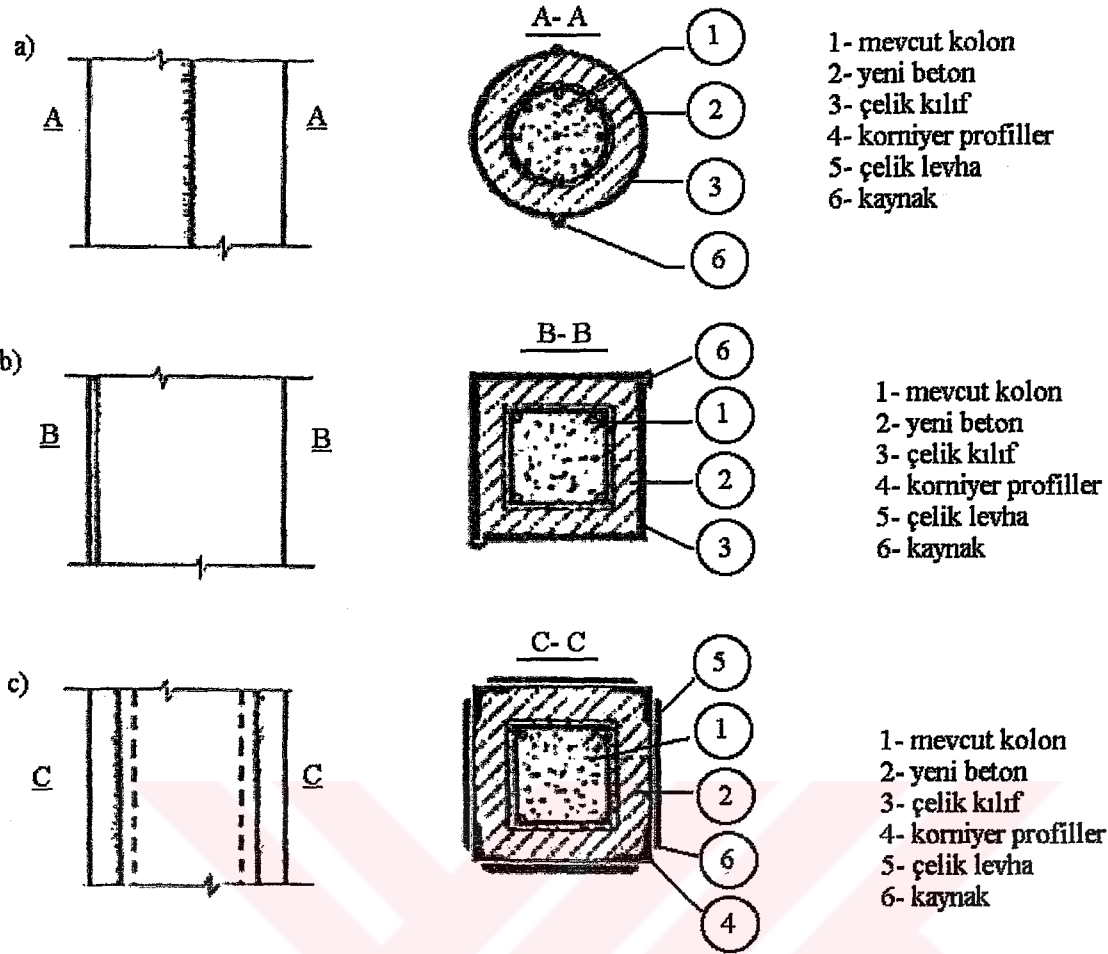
Kolonda çelik manto uygulaması ile onarım ve güçlendirme.
